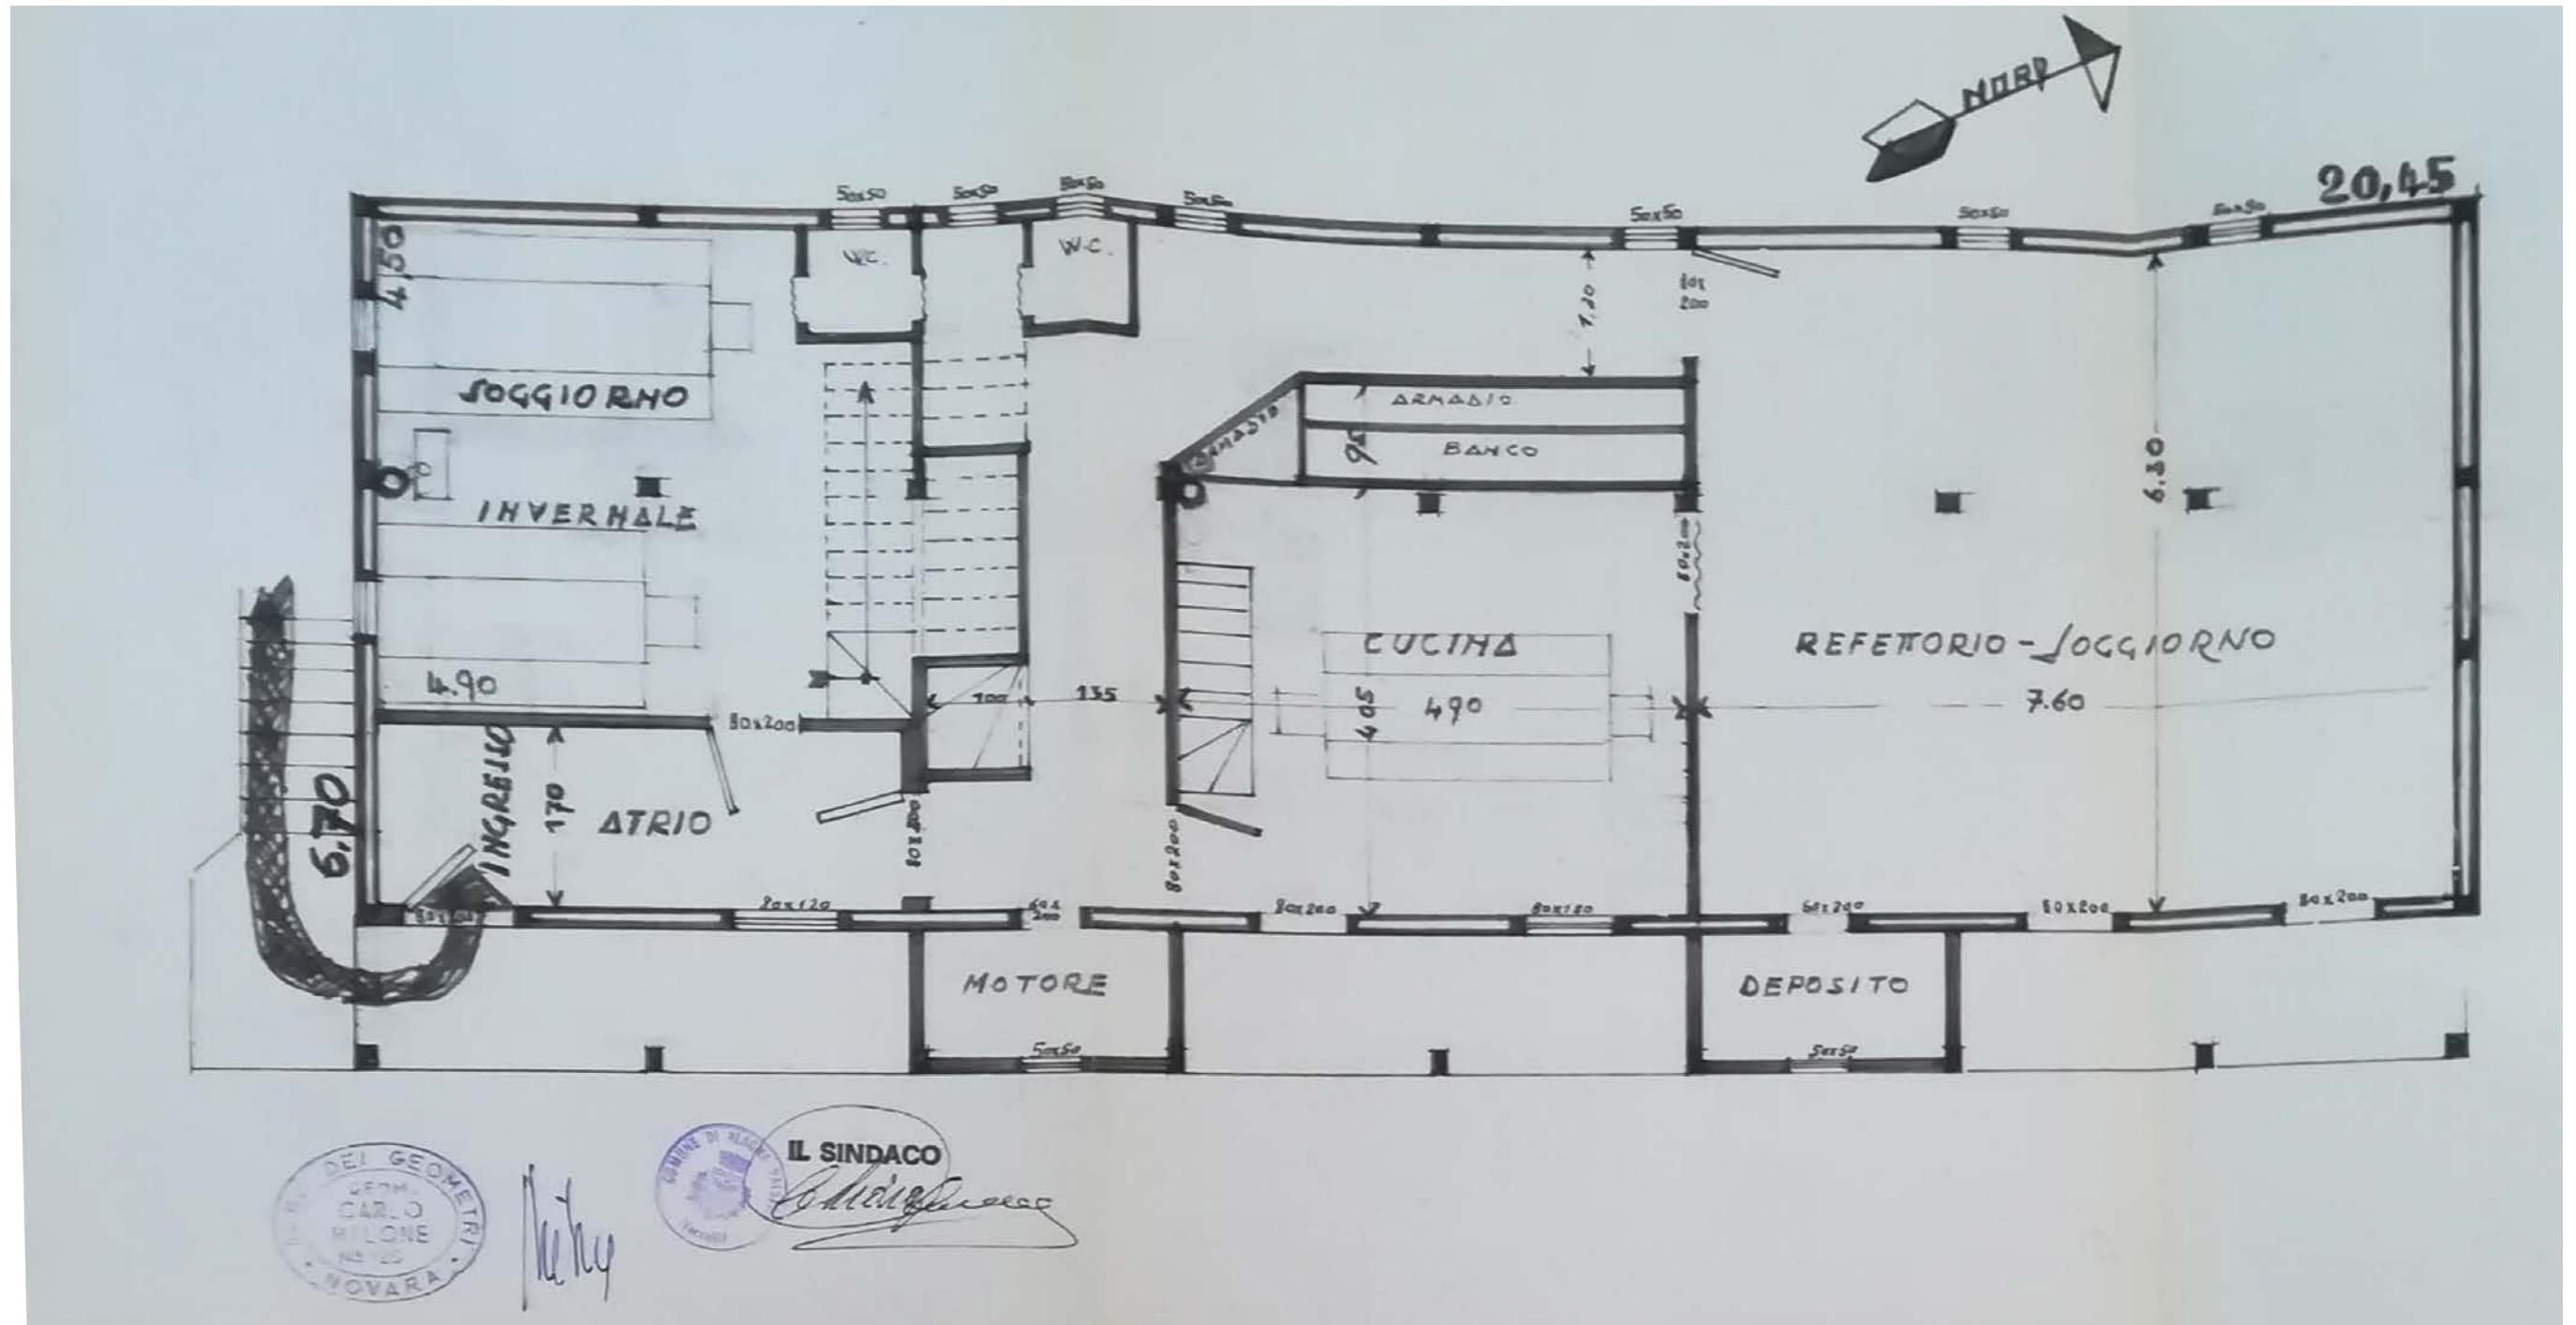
Pianta piano terra progetto originale del 1977 redatto dallo studio del geometra Carlo Milone.
